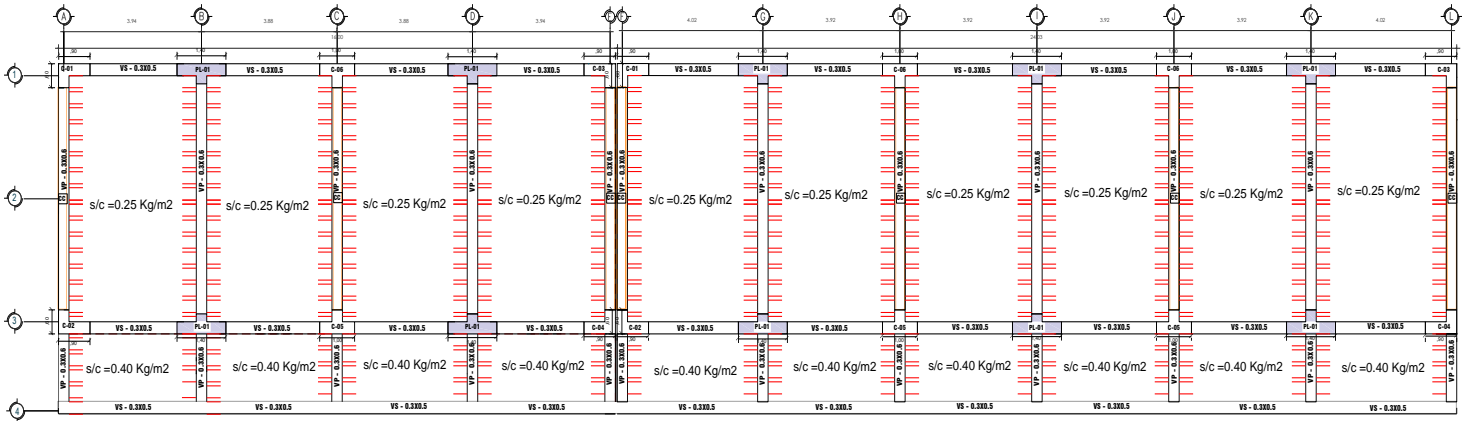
Configuración estructural de la nueva propuesta de estructuración.
